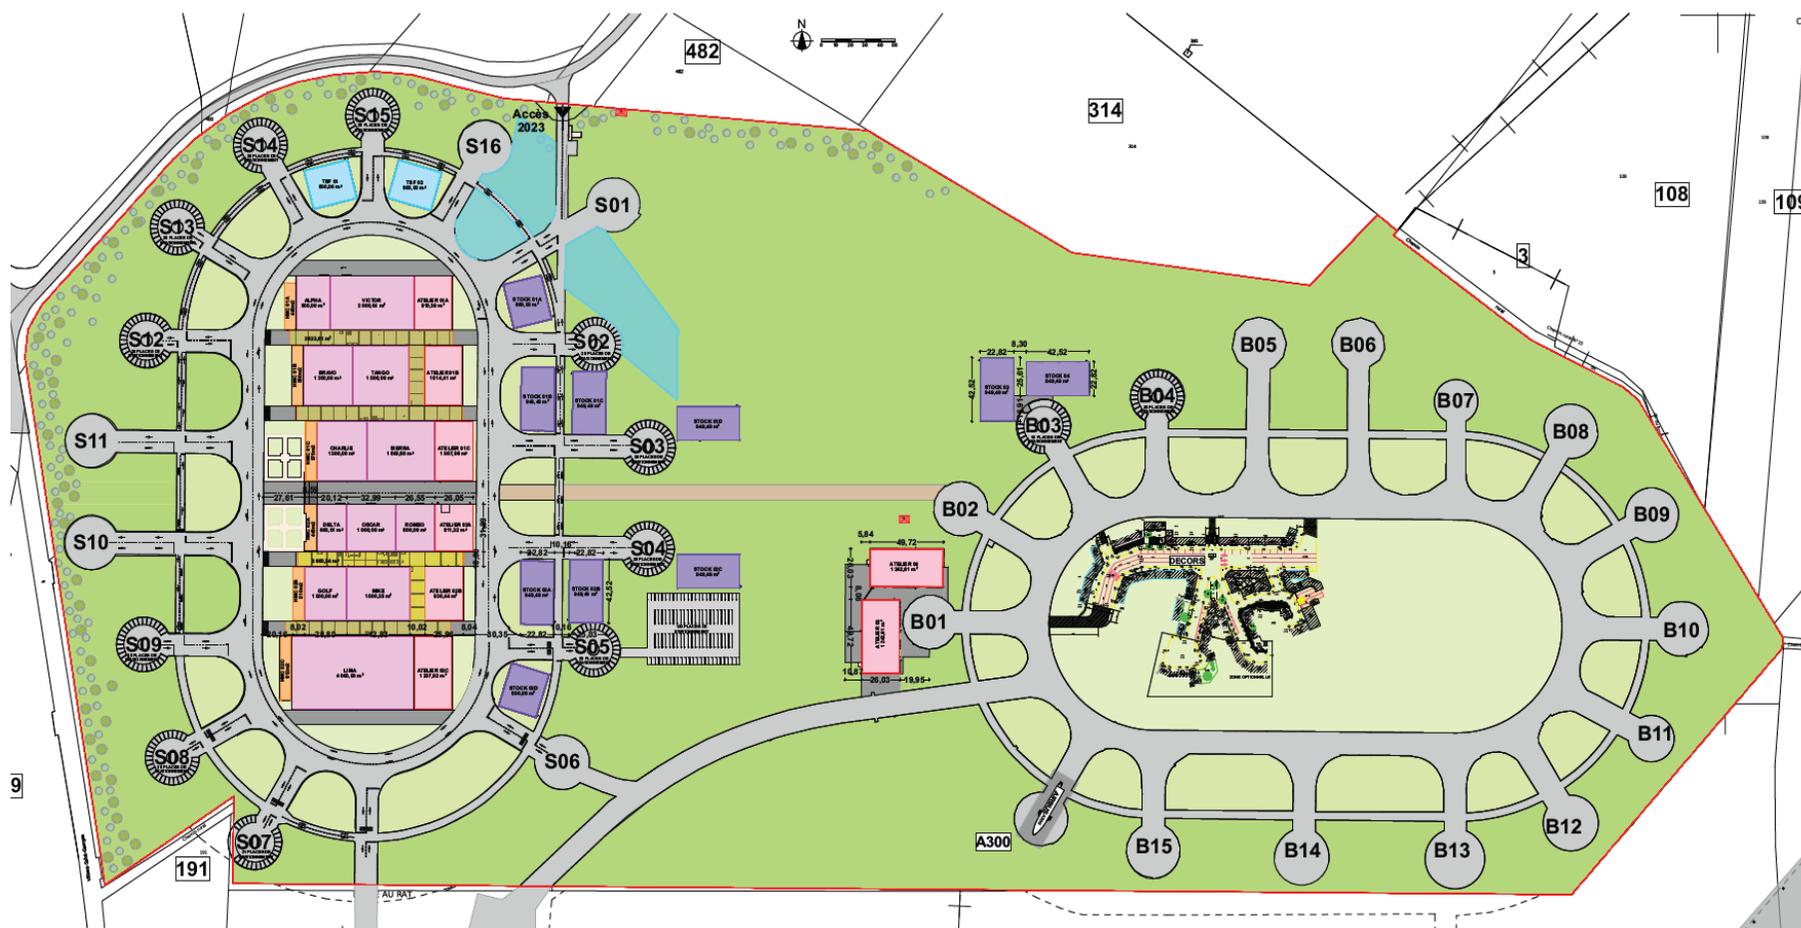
Plan masse du projet (Source : AMJ - 19/07/2024)
